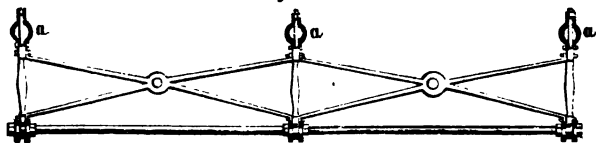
bis 167. Details zur Fußbrücke über den Stadtkanal zu Potsdam.
